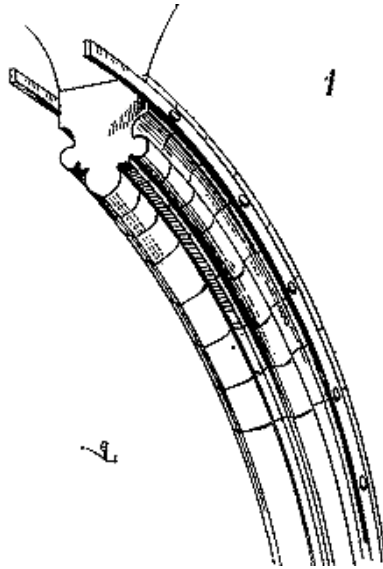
Gambar Detail Potongan Sebagian Bangunan Katedral Amiens. Viollet-le-Duc menilai kekuatan konstruksi yang ada pada abad ke-13 (Viollet-le-Duc).
